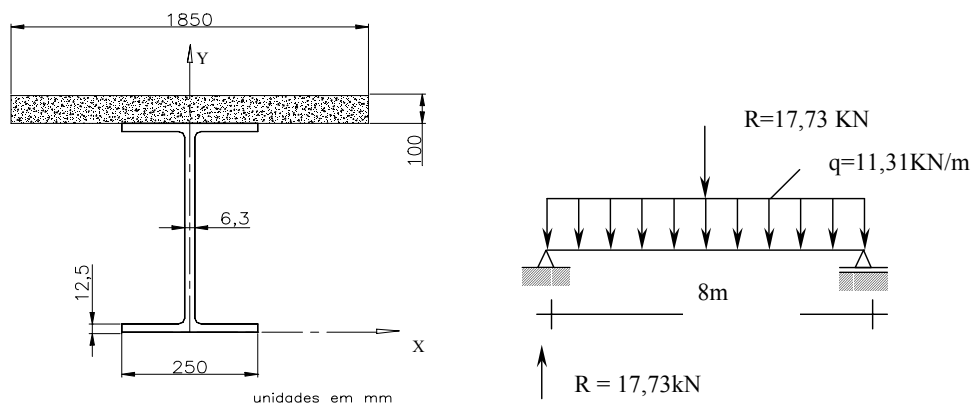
Seção transversal e esquema estrutural da viga V4
